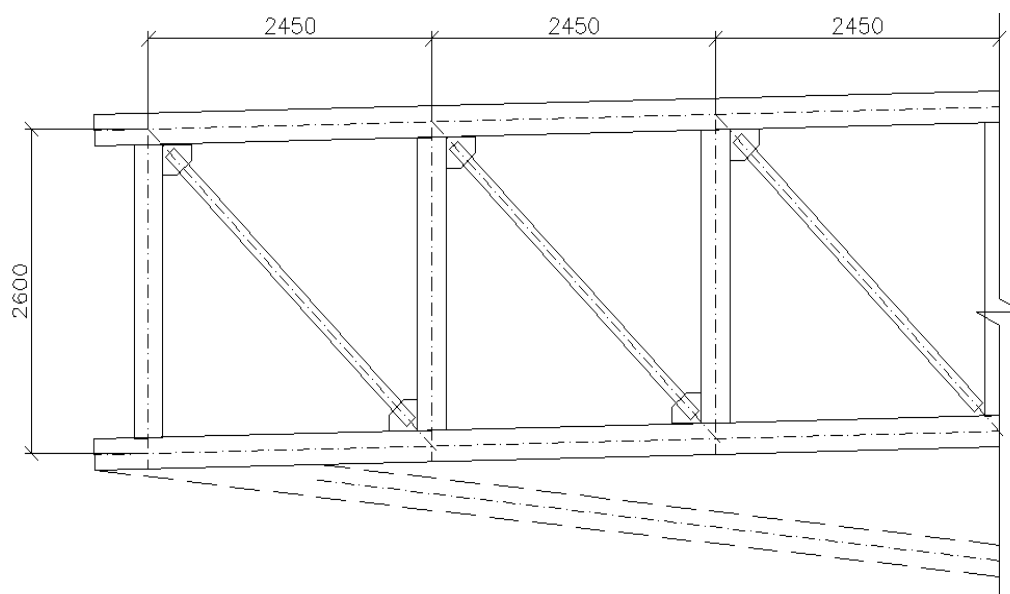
Detalhe da vista lateral dos módulos treliçados (dimensões em mm)
